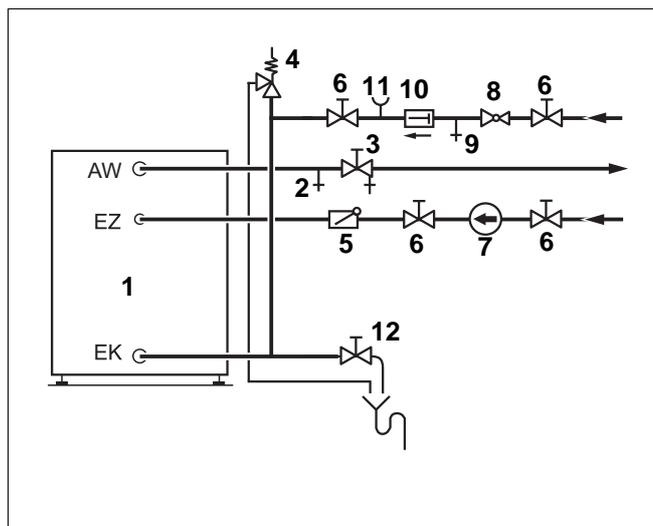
Instalação conforme a DIN 1988 (esquema de princípio)
